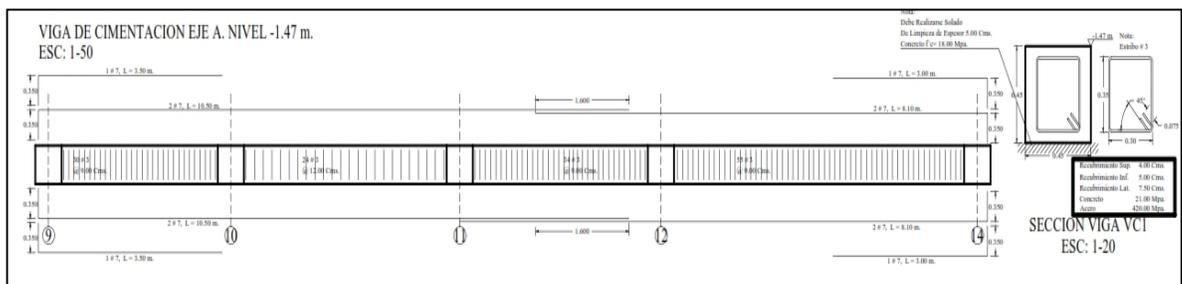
, Despiece de acero viga de cimentación de los ejes A y E-F. Fuente: Constructora Open House.
